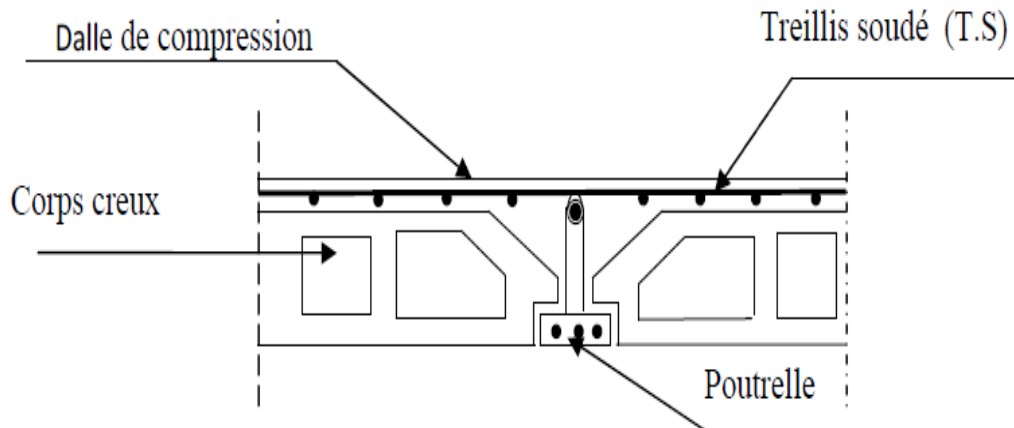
Coupe verticale sur un plancher en corps.
